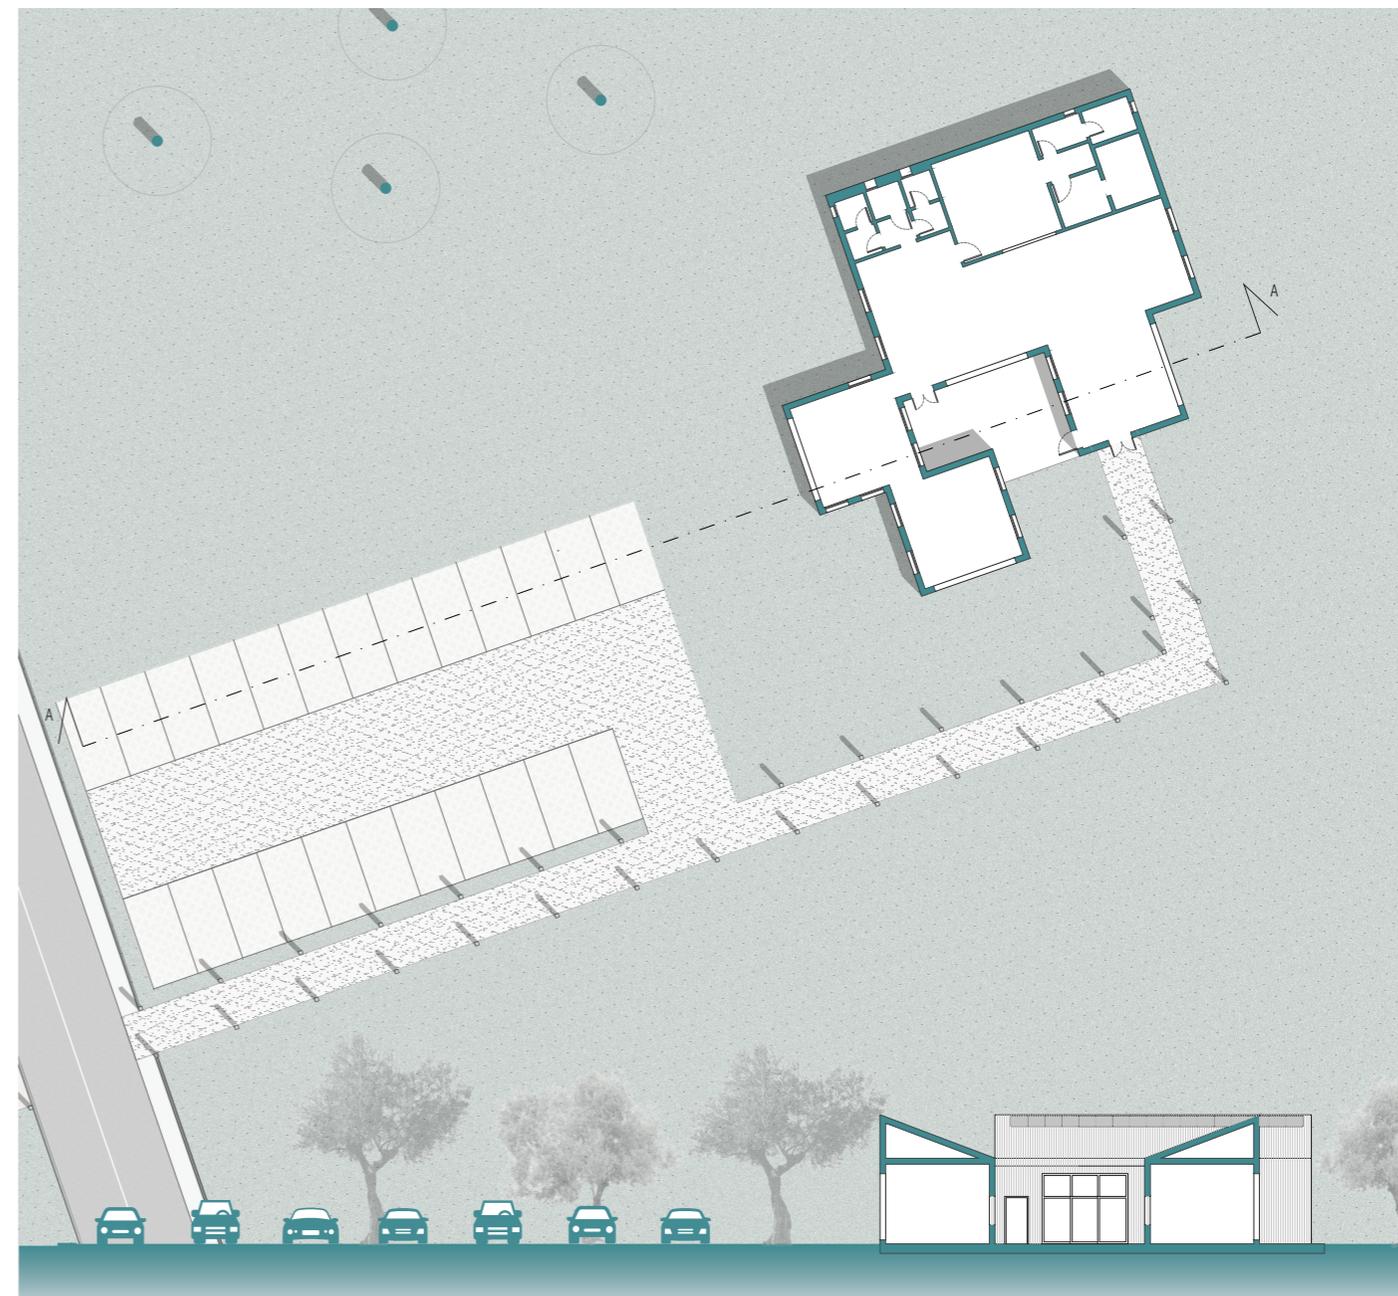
Pianta attacco a terra - sezione AA'. Scala 1:500
